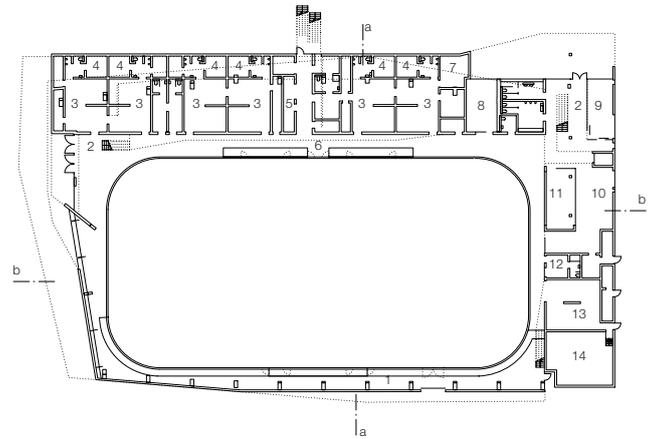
Grundriss Ebene 00 - Eissporthalle St. Pölten
